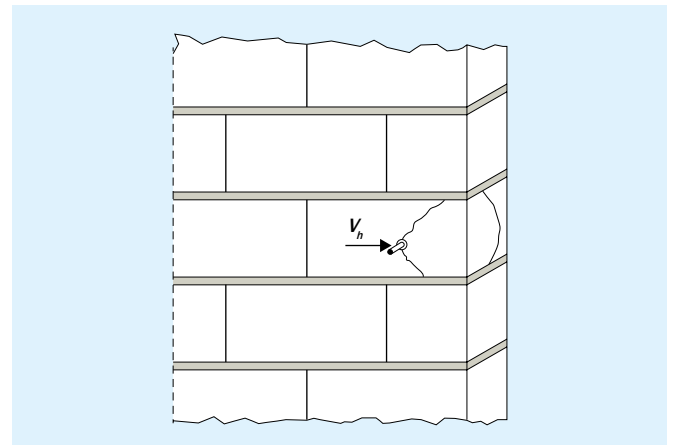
Steinkantenbruch am Mauerwerksrand [9]
